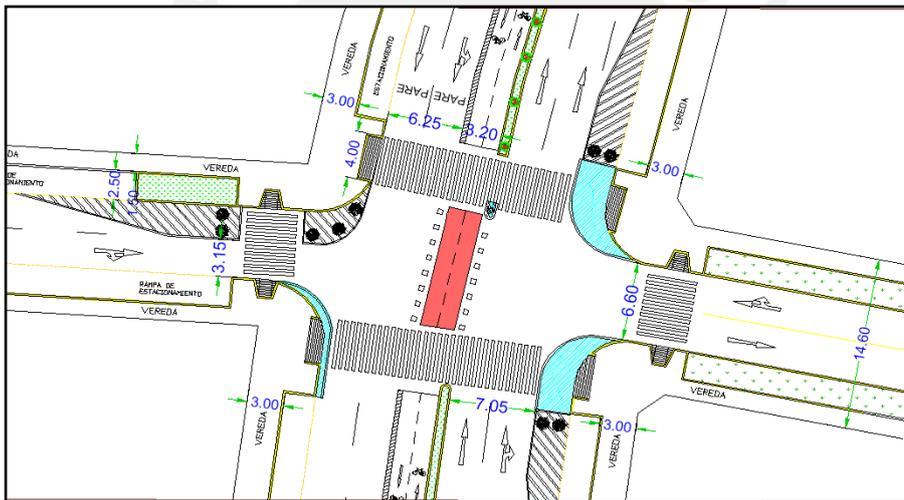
Vista en planta de la situación propuesta de la Av. Parinacochas con Antonio de la Guerra
